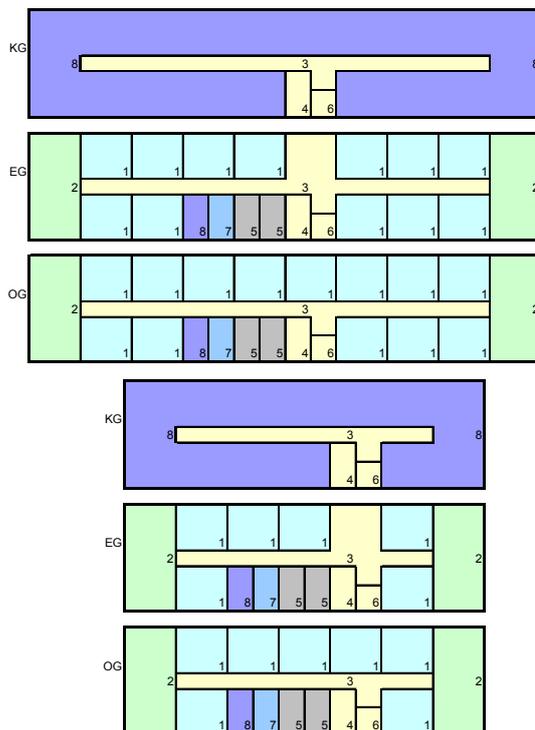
Grundrisse und Zonen der betrachteten Gebäude (links: Länge 60 m, rechts: Länge 42 m).
